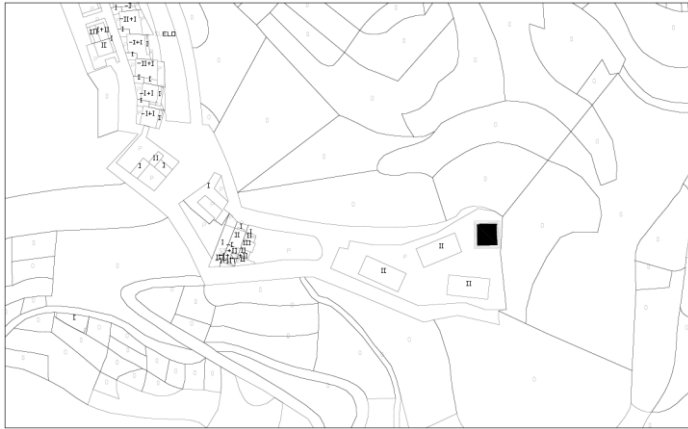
Plano emplazamiento de la vivienda. Fuente propia
